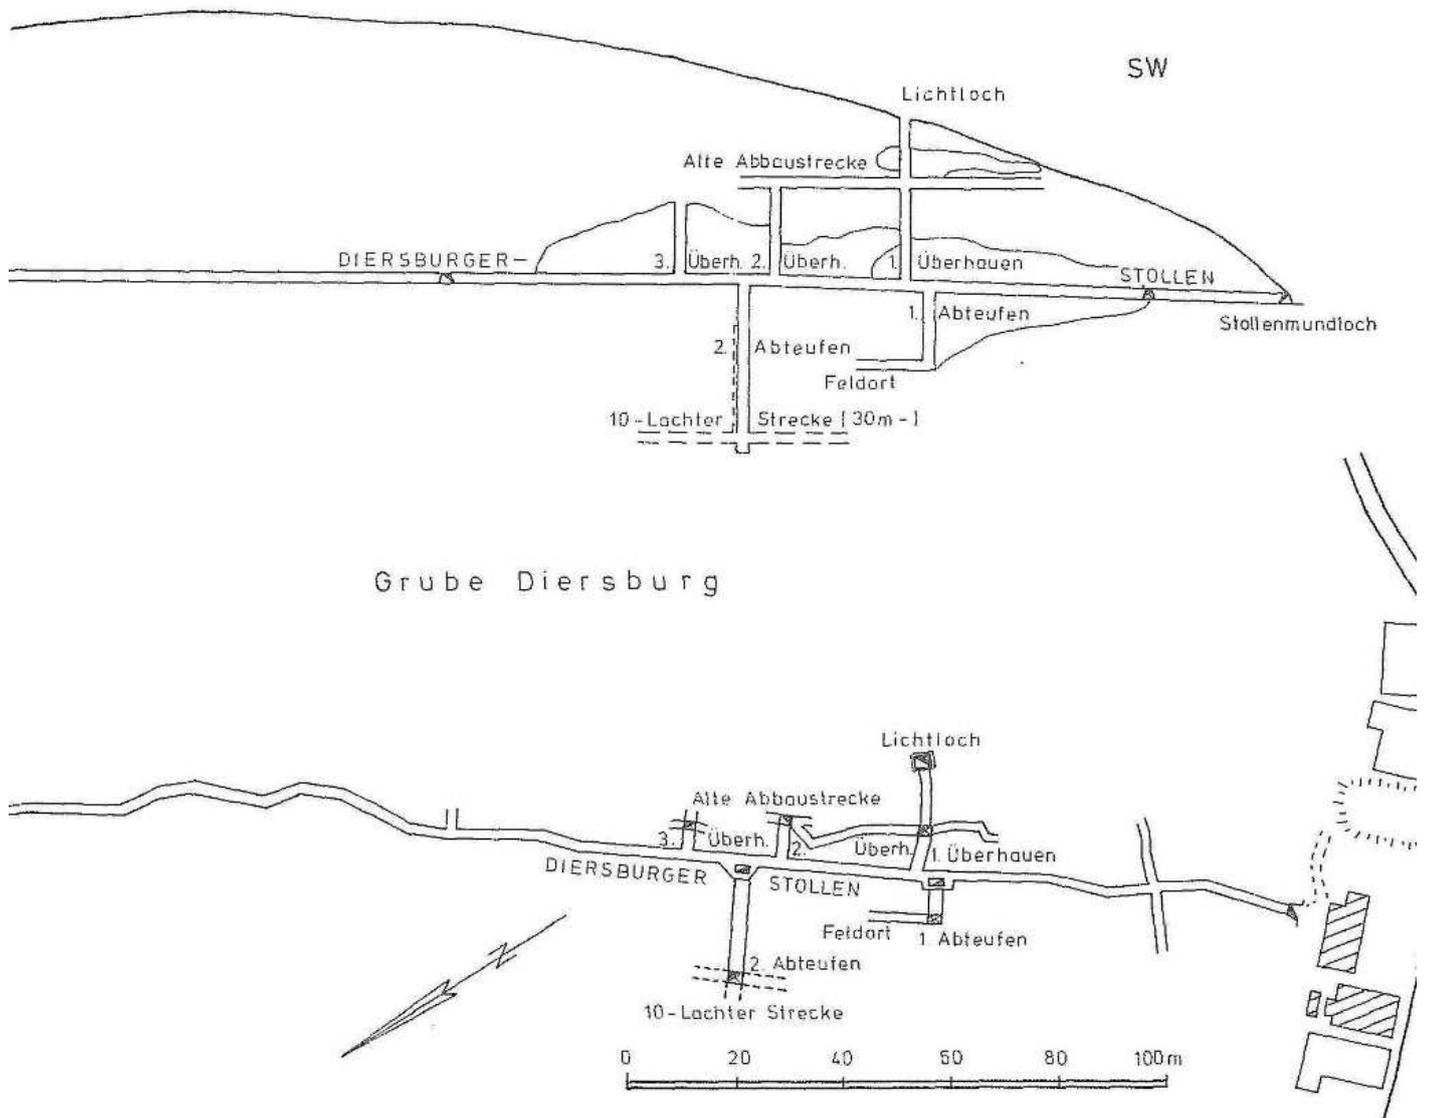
Längsschnitt und Grundriss der Grube Diersburg [3, S. 160]
